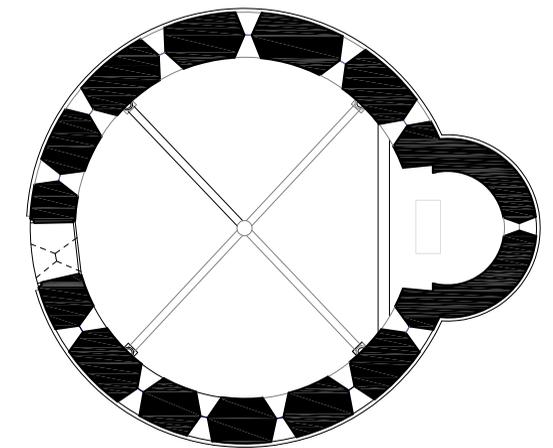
Grundriss St. Lambrecht, M 1:200. TU Graz/Hornyak, Tappeiner 2008.
